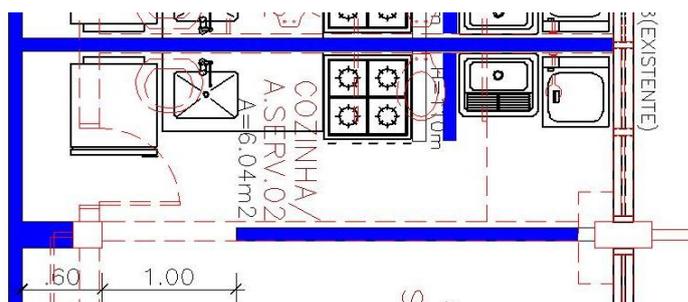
Ilustração de Detalhe de cozinha em Planta Baixa de Pavimento Térreo.
